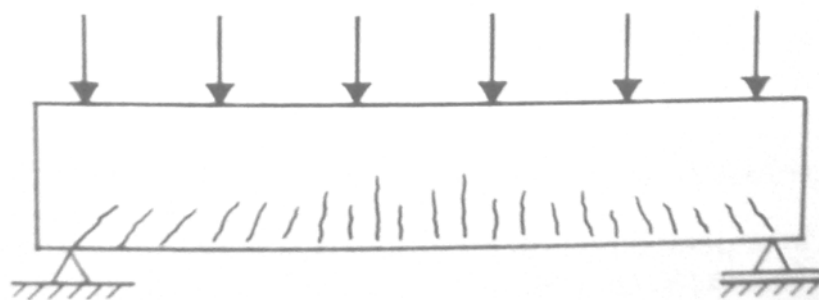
Fissuração típica em viga subarmada solcitada à flexão. (Fonte: THOMAZ)
